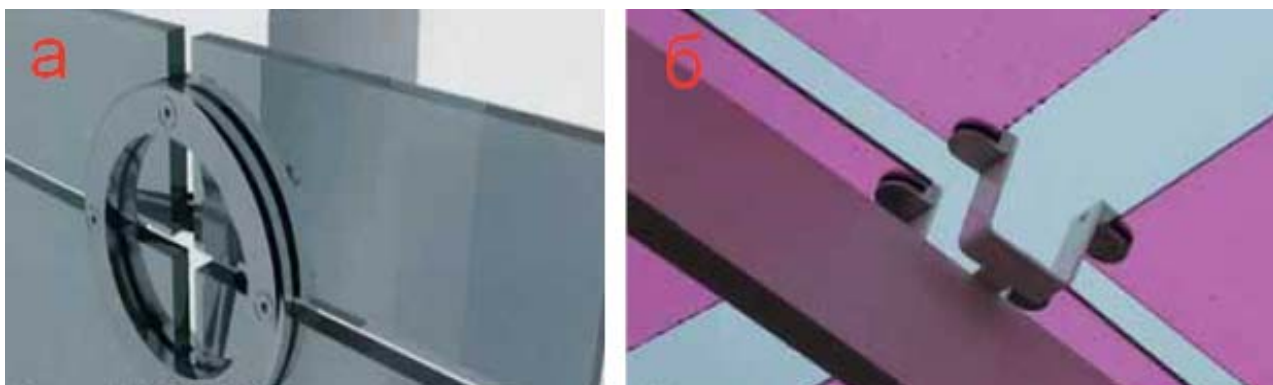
Способы создания стеклянных оболочек фасадов при реконструкции фасадов зданий разработки компании «ЭНТЕК»: *a* – QUADRIFOGLIO SYSTEM; *b* – применением индивидуальных легких кронштейнов [12]
